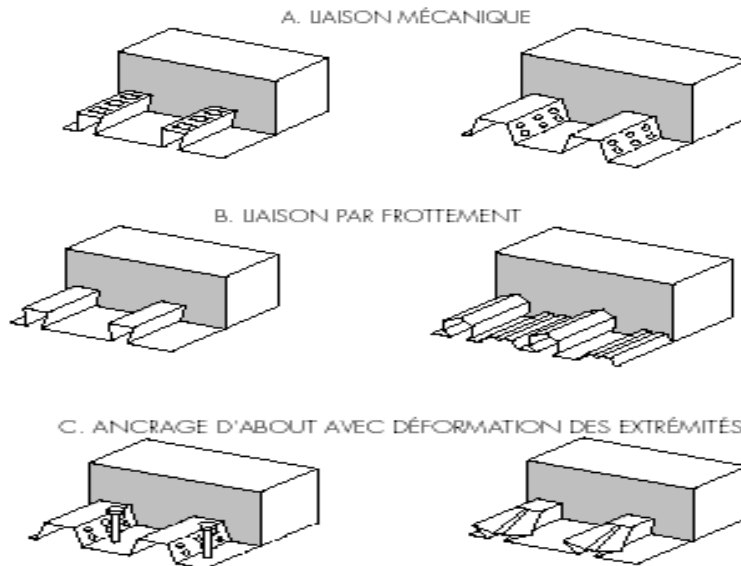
Dalles mixtes avec tôles profilées collaborantes.
